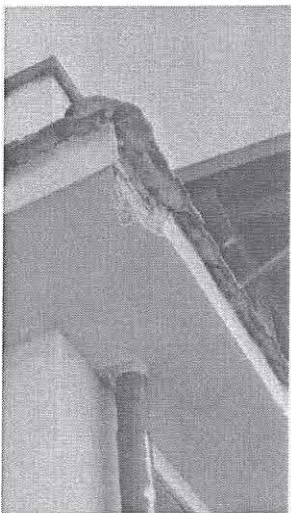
distacchi dell'intonaco e fessurazioni nei pilastri del porticato
